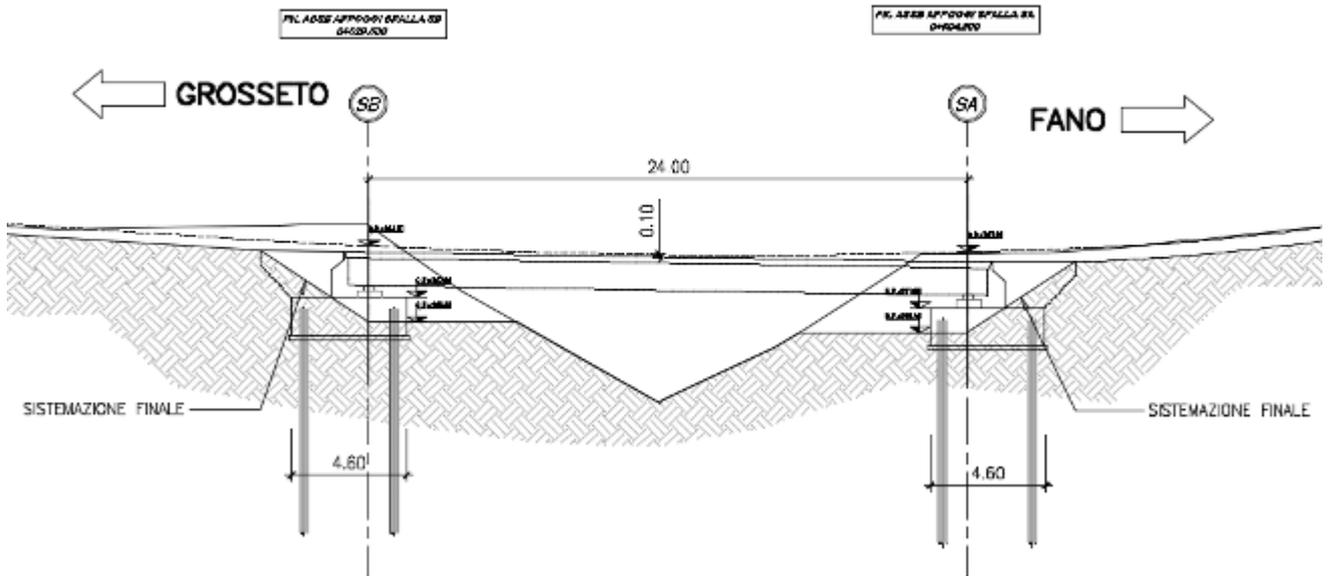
Profilo longitudinale opera su viabilità secondaria
